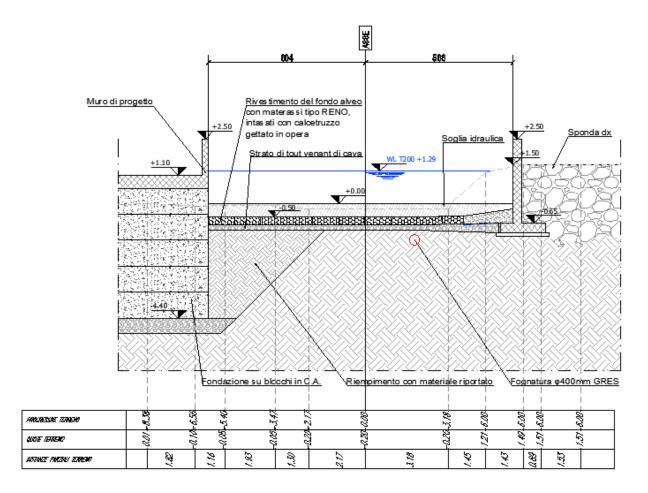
Stralcio dell'aggiornamento della sponda in destra idraulica tramite inserimento di un muro di sponda (sezione 11)
